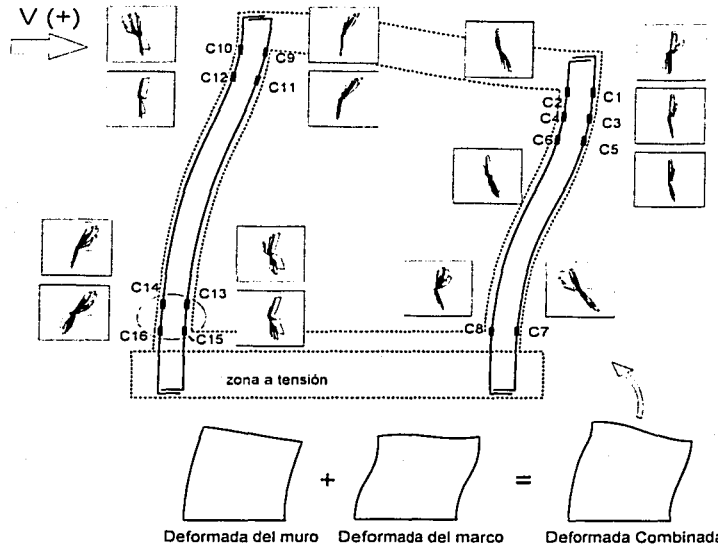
Deformación esquemática en las columnas del espécimen TD deducida de los deformímetros
